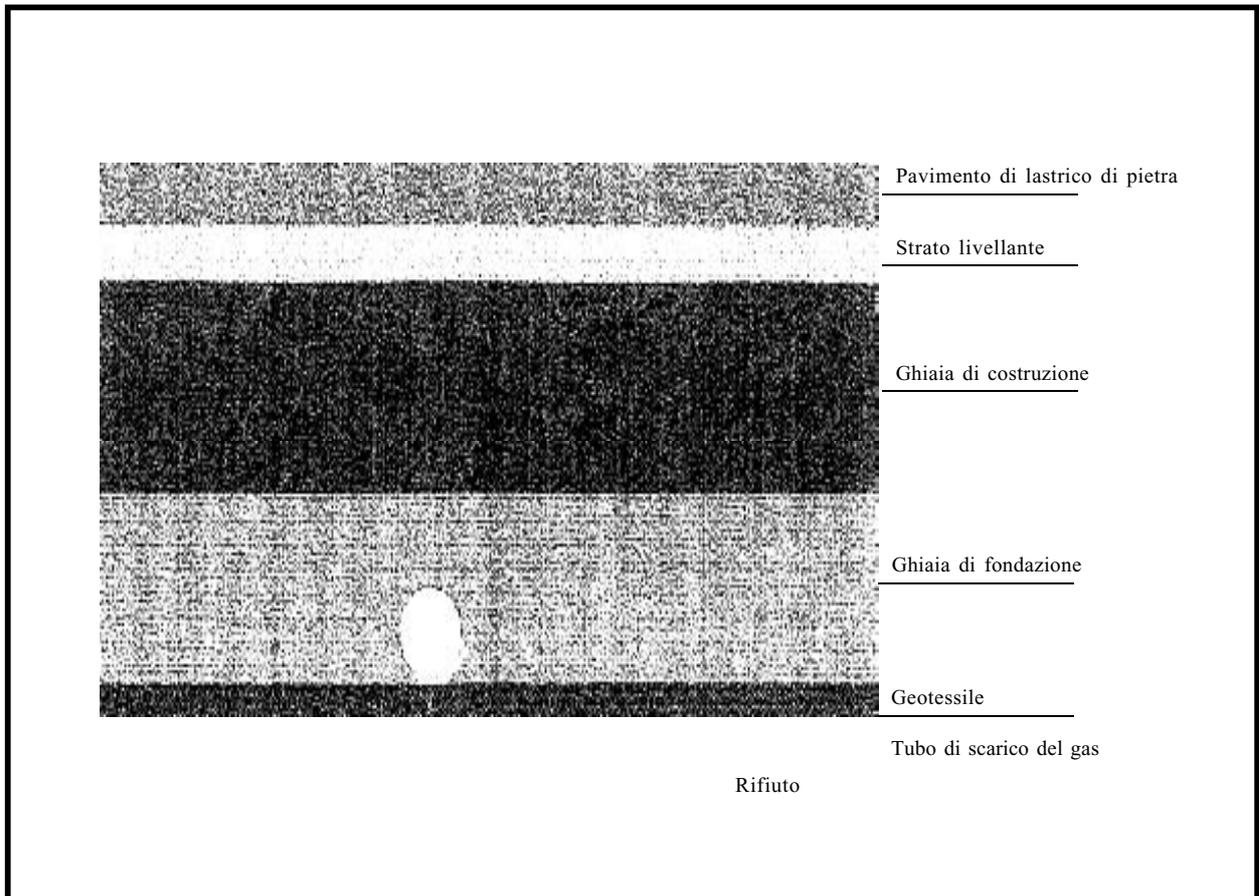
Pavimento e sistema di ventilazione sotto l'area di parcheggio
